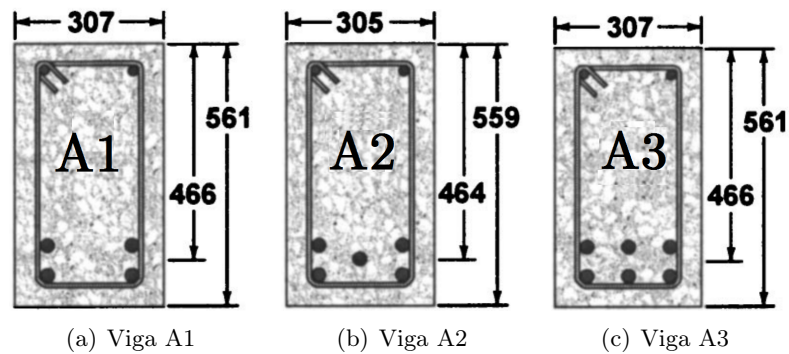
Vigas ensaiadas por Bresler e Scordelis (1963)
